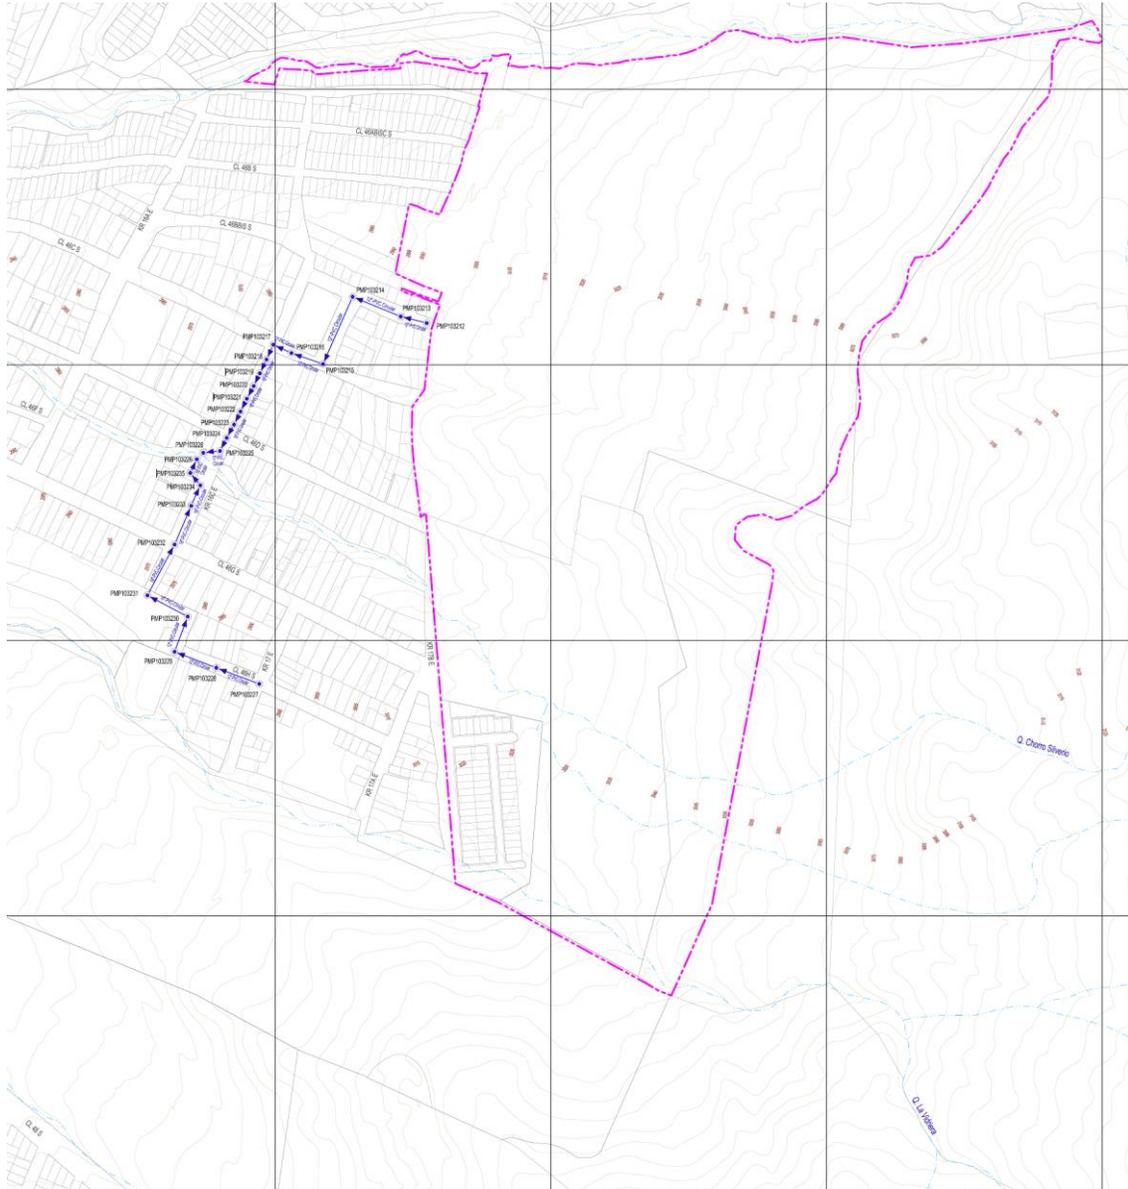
Redes de alcantarillado sanitario existentes en el área del Plan Parcial
